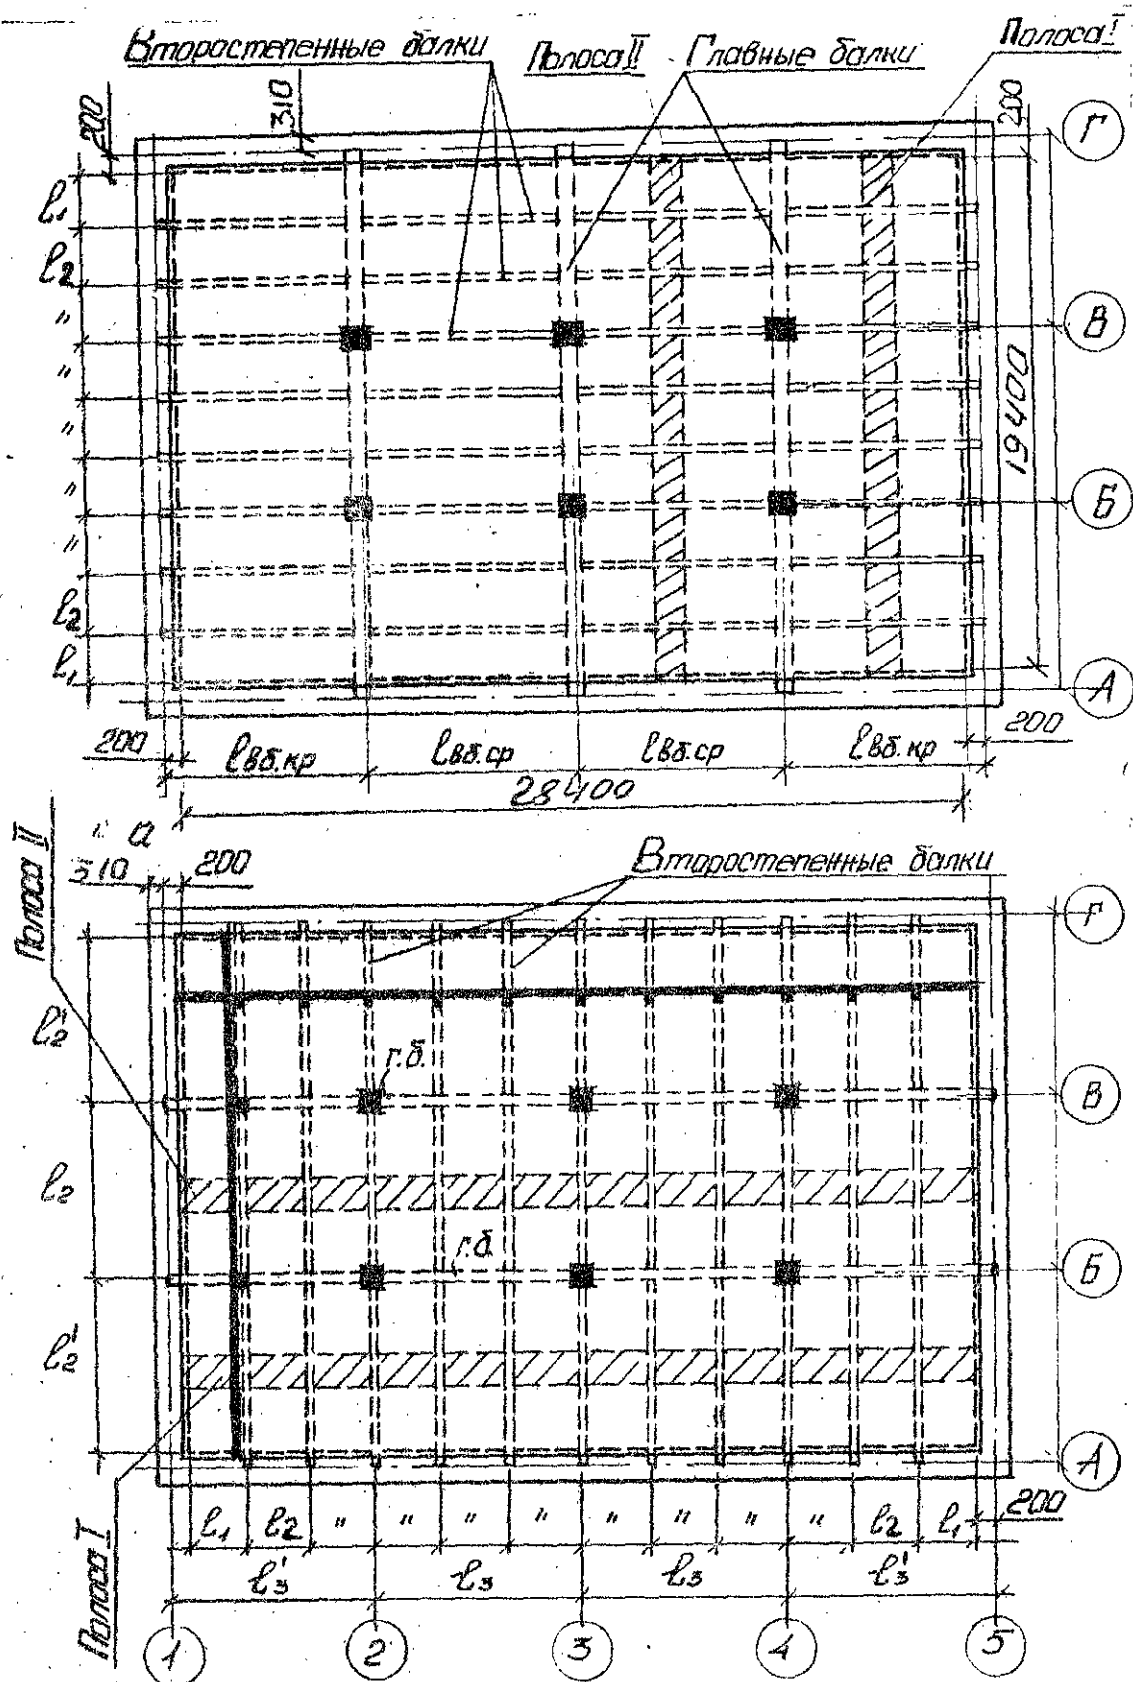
Конструктивная схема перекрытия: а - главные балки расположены поперек здания; б - то же вдоль здания
